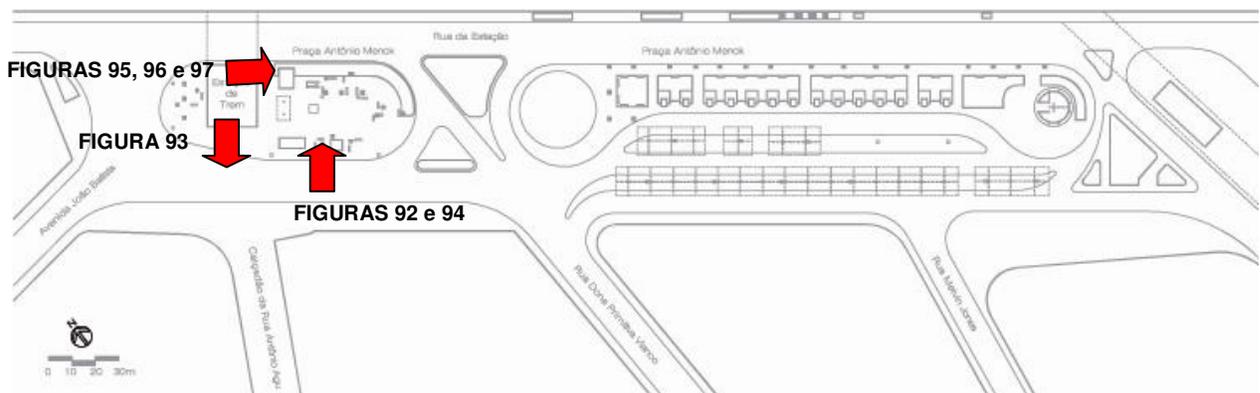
Planta da Praça Antônio Menck com as indicações das fotos.
